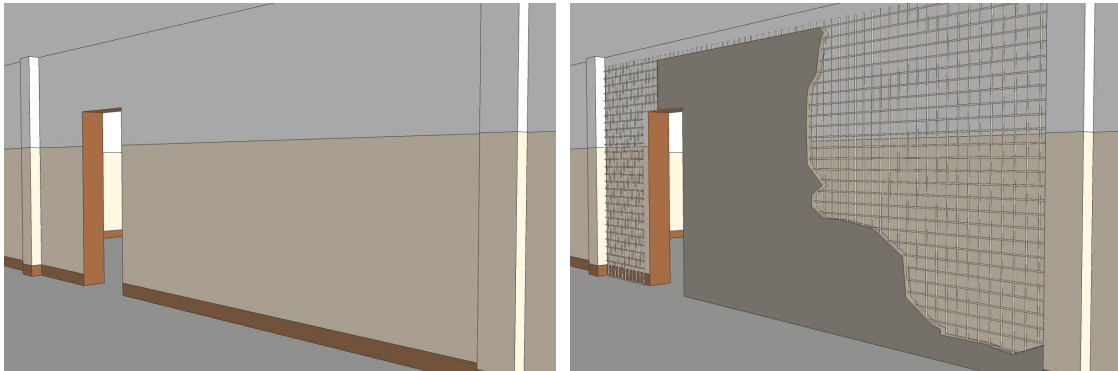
Eliminación de columnas cortas y uso de mampostería con friso armado.
